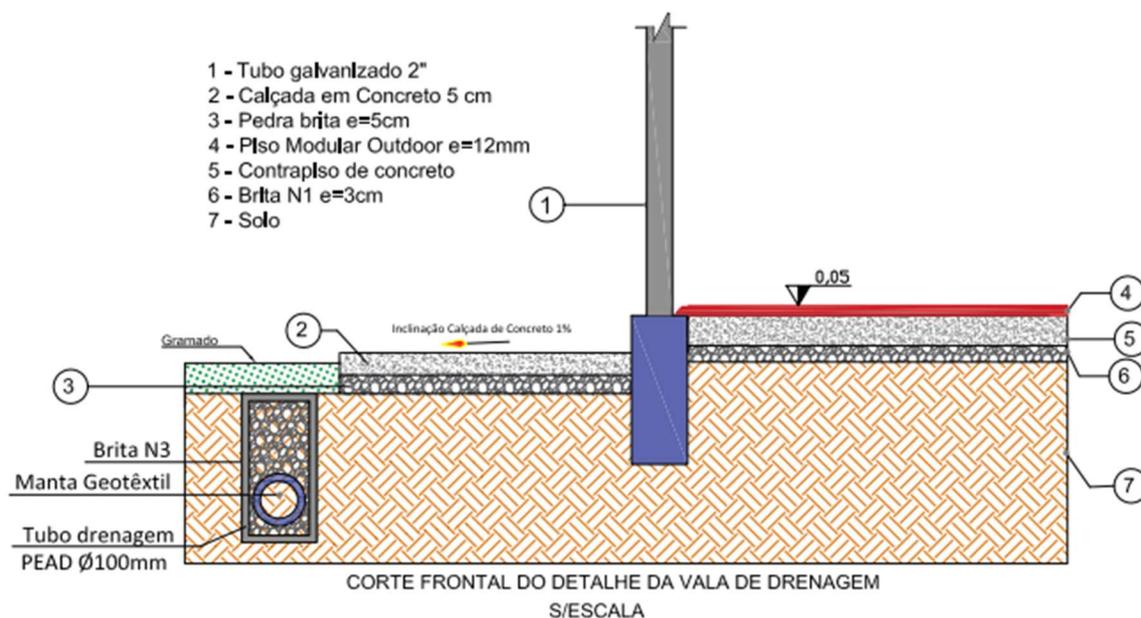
Detalhe de instalação Drenagem (Fonte: Autor/2025)
